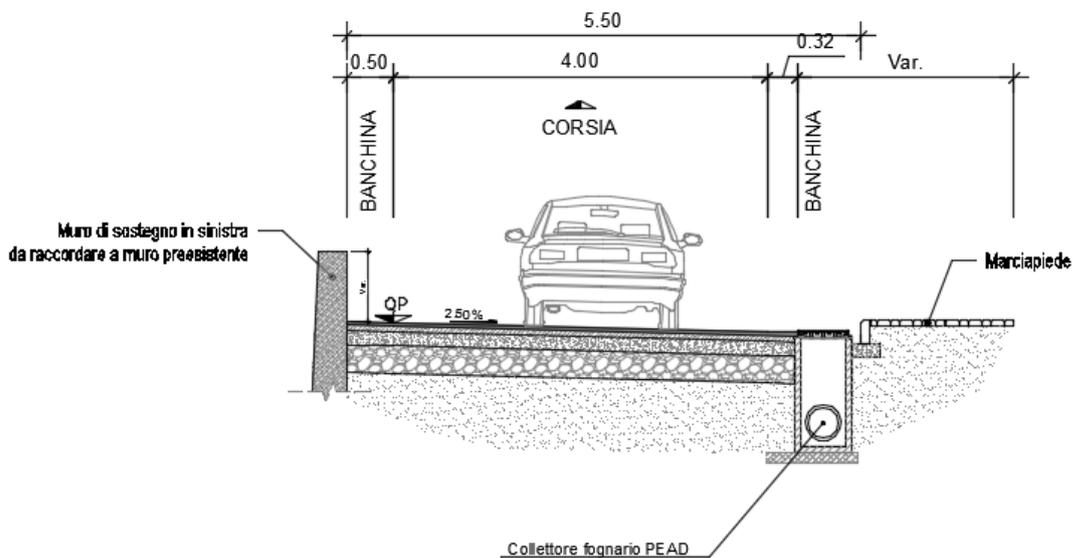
Sezione rampa di accesso a nuova viabilità (affiancamento muro in sinistra)
